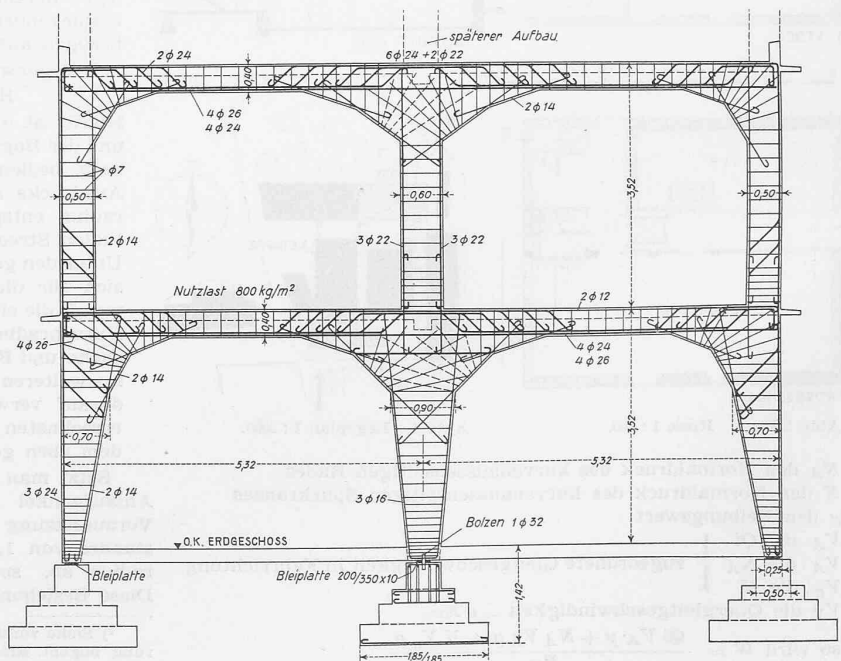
Eisenbetonrahmen des Neubaus 1933. — Masstab 1 : 100.
